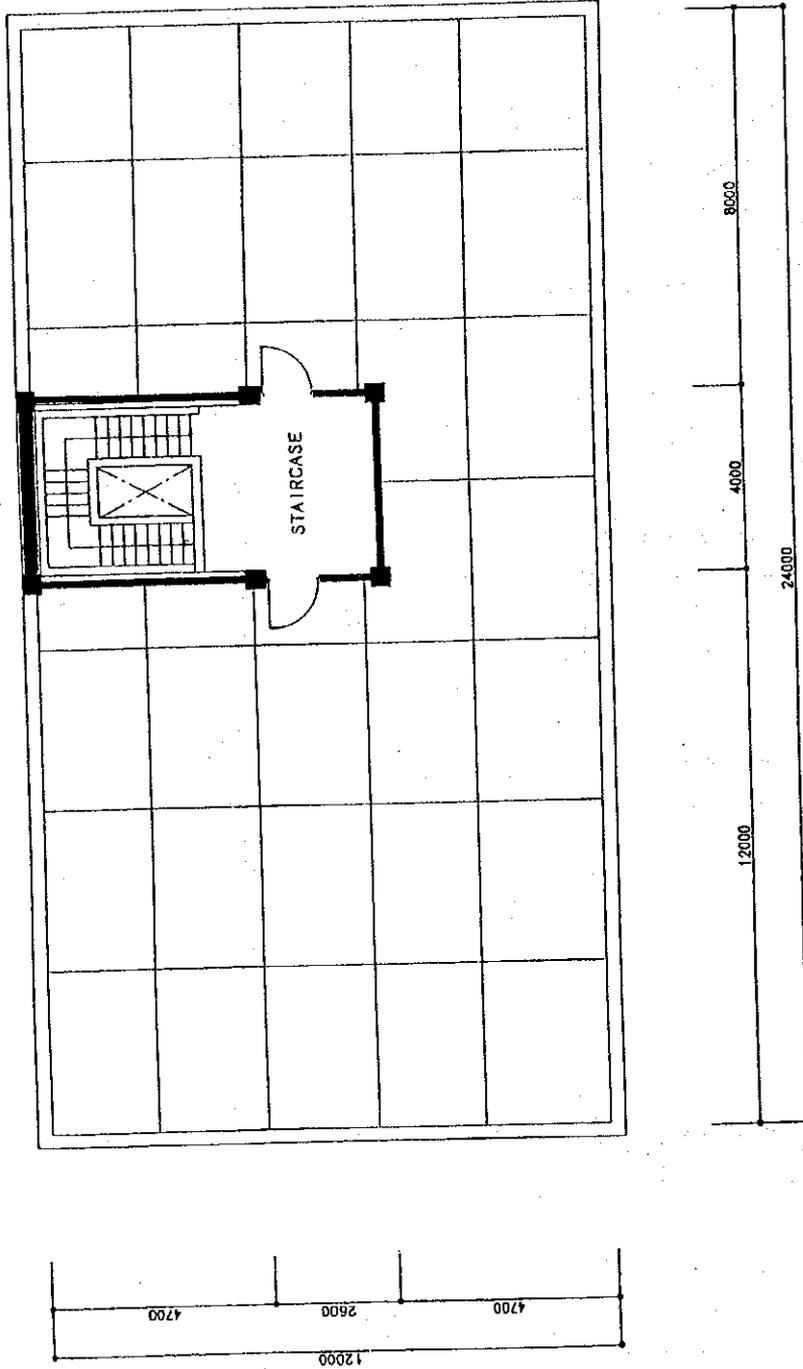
(3) 屋階平面図 (4 教室タイプ)
